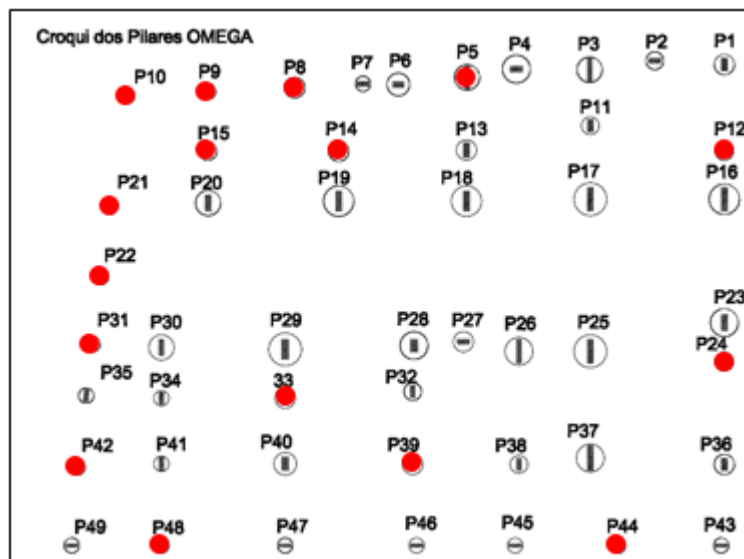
Disposição dos pilares da edificação (Fonte: Planta baixa de locação das estacas).
